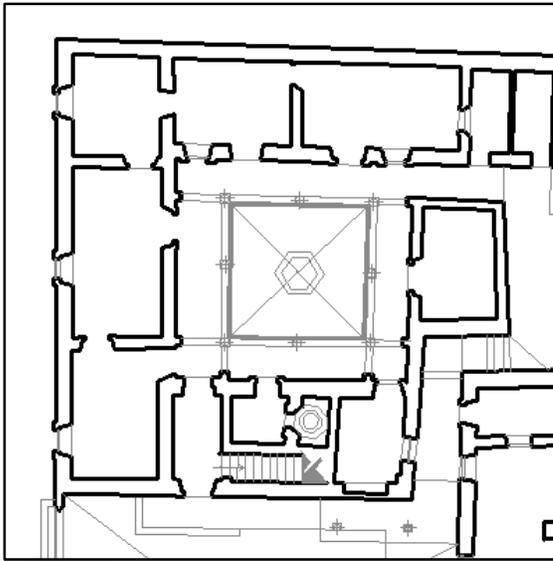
Planta baja de la celda de María Anna Pimentel. Plano José Martín Torres Vega.
